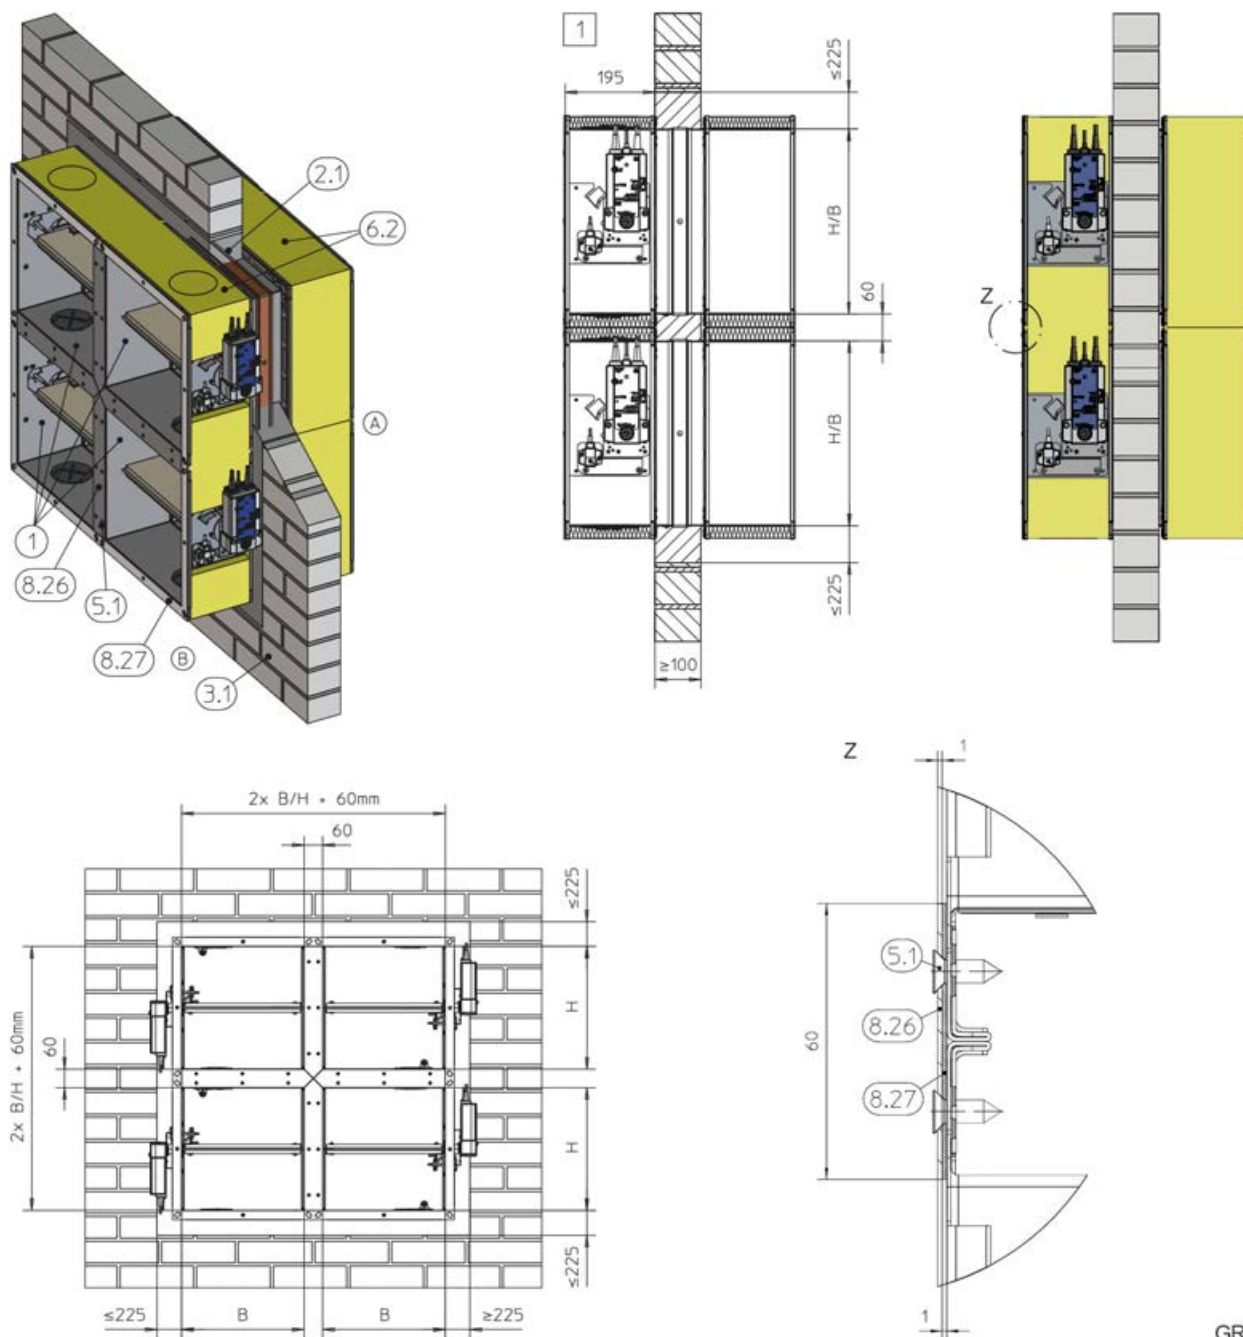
Installazione in muratura – installazione multipla in un'apertura di installazione
